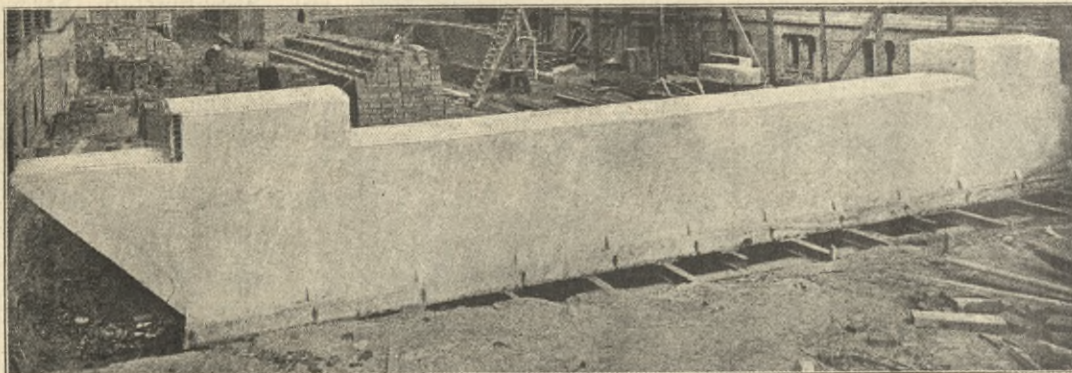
Personentunnel in Amsterdam vor seiner Versenkung.
